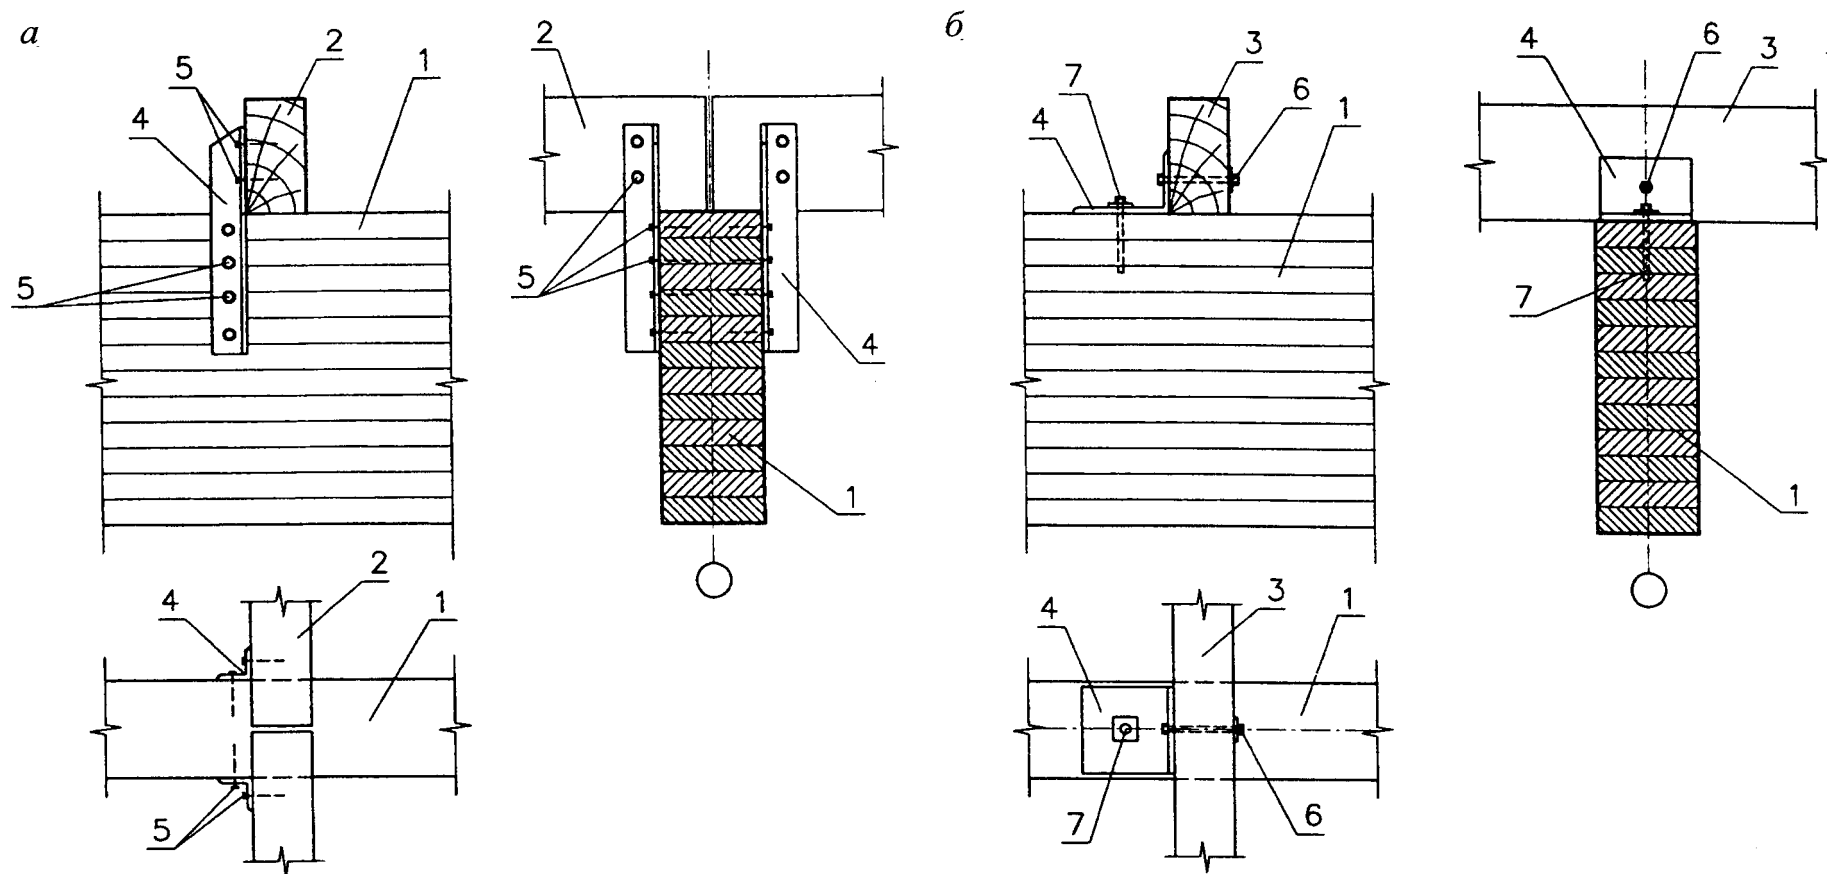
Узлы опирания прогонов на балку покрытия:
